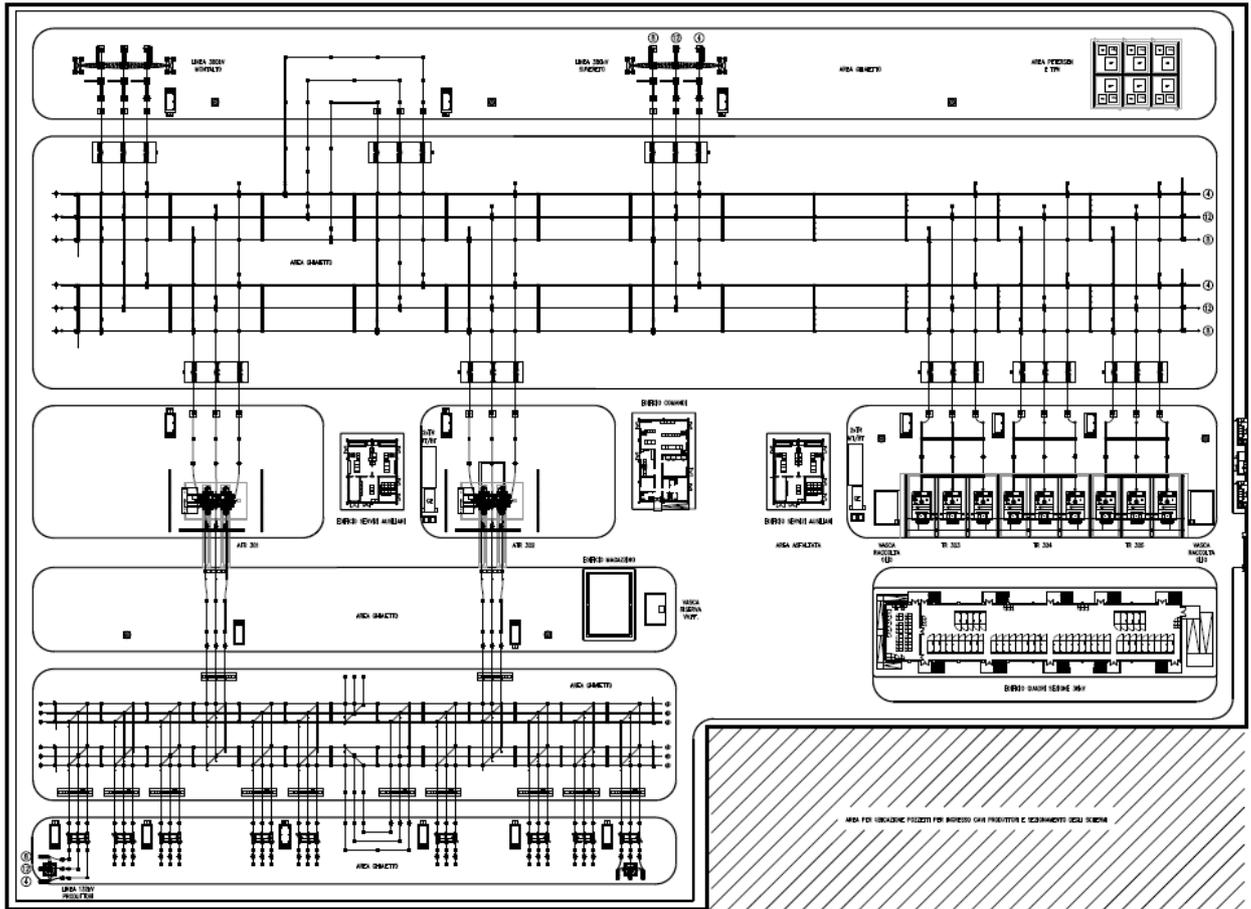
Planimetria reparto AT nuova SE 380/132/36 kV Manciano
